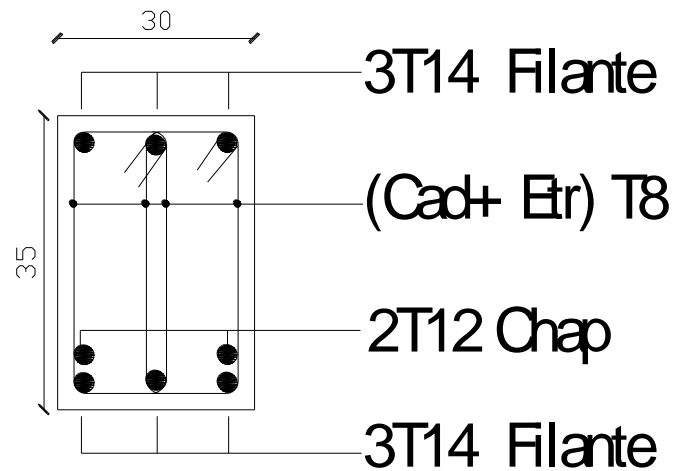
Ferraillage en travée d'une poutre principale.
